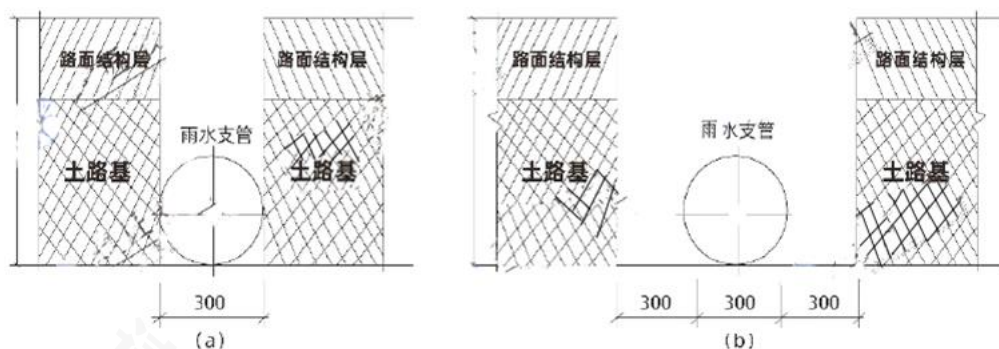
雨水支管沟槽开挖断面示意图（单位：mm）
